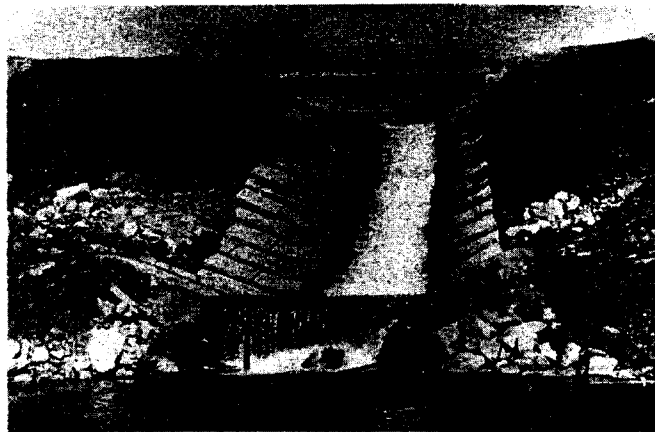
Крепление откоса грунтовой водосливной плотины Амманнчаной сборными железобетонными плитами типа «чешуи»
